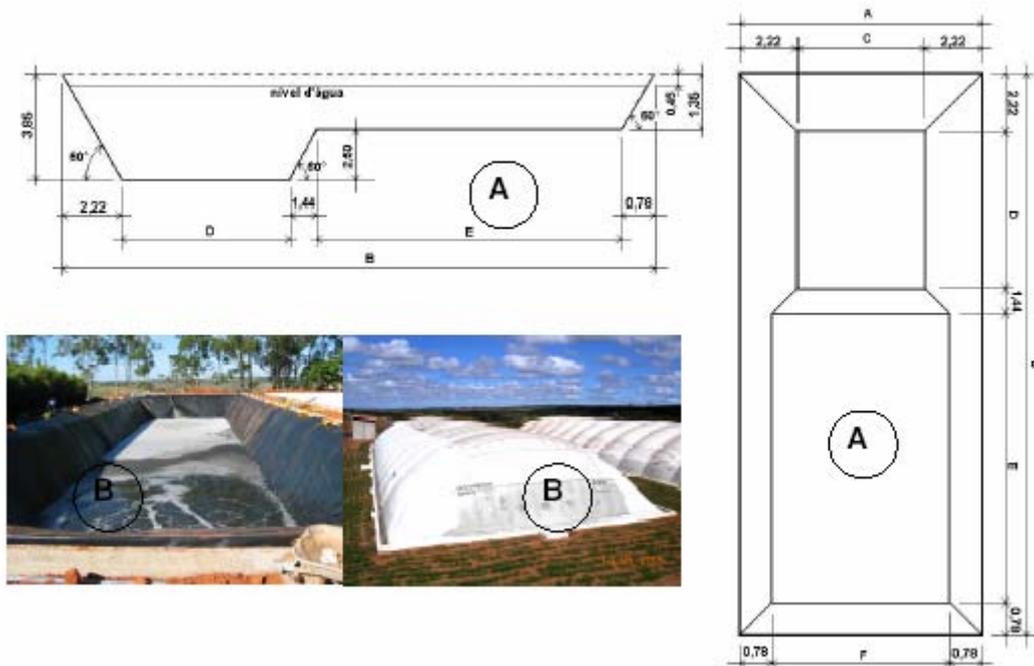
Modelo de Biodigestor de gasômetro de PVC adotado pela empresa Agcert em planta baixa (A) e construído (B).
